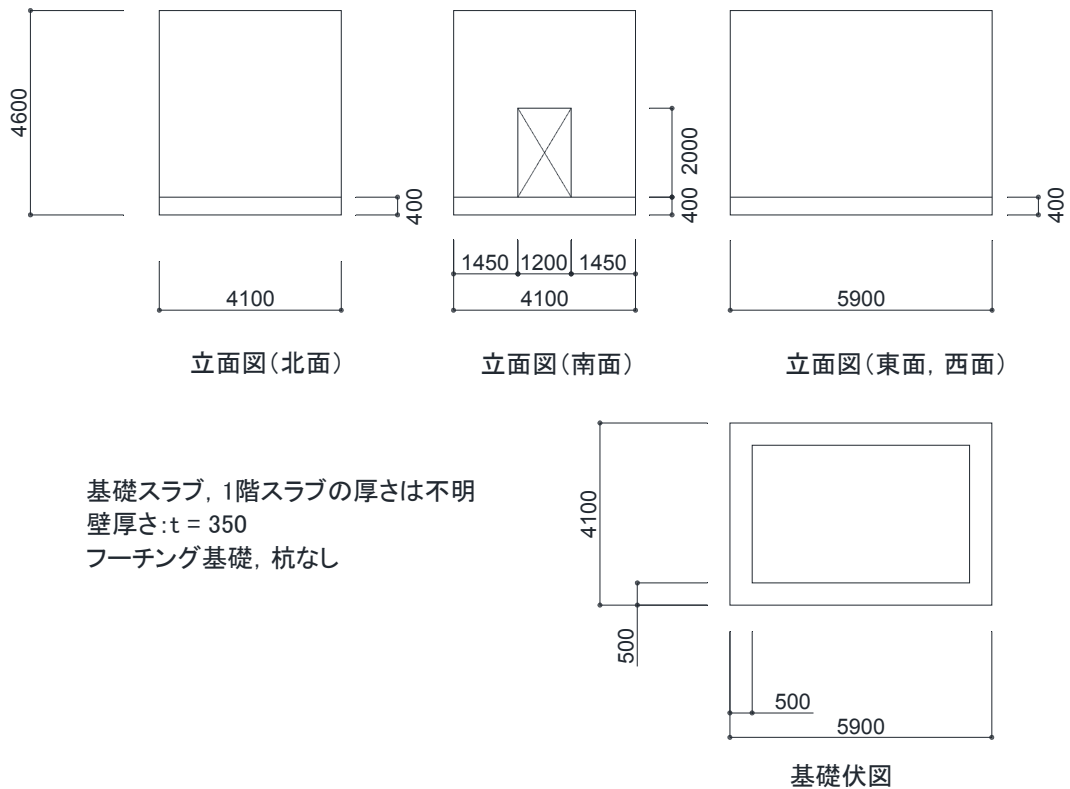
調査対象建物 立面図 (流失前の G.L.は不明) (単位: mm)
